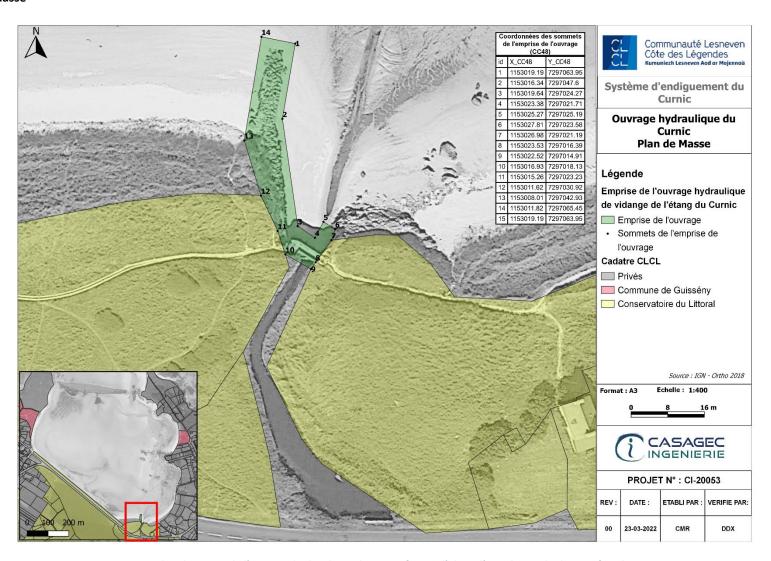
Plan de situation de l'ouvrage hydraulique du Curnic dans le système de protection
